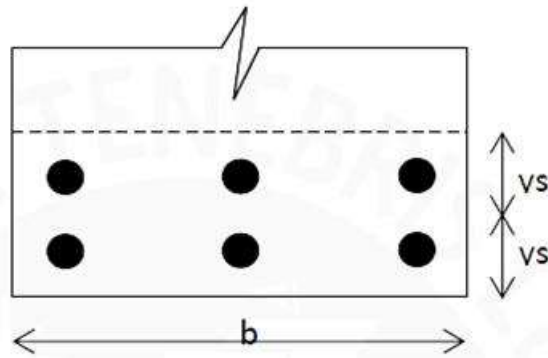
Área efectiva de concreto en tracción A_{ct} .
